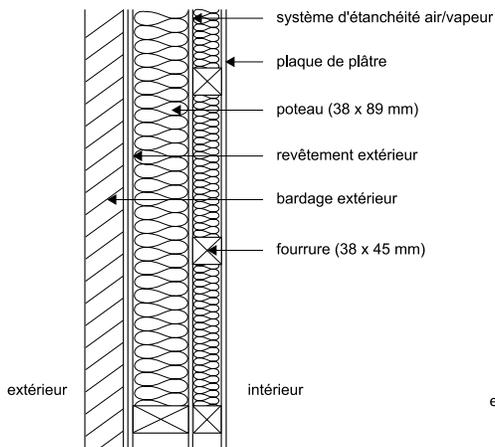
Coupe verticale d'un mur dont le système d'étanchéité à l'air et à la vapeur est mis en place entre les poteaux et les fourrures internes
